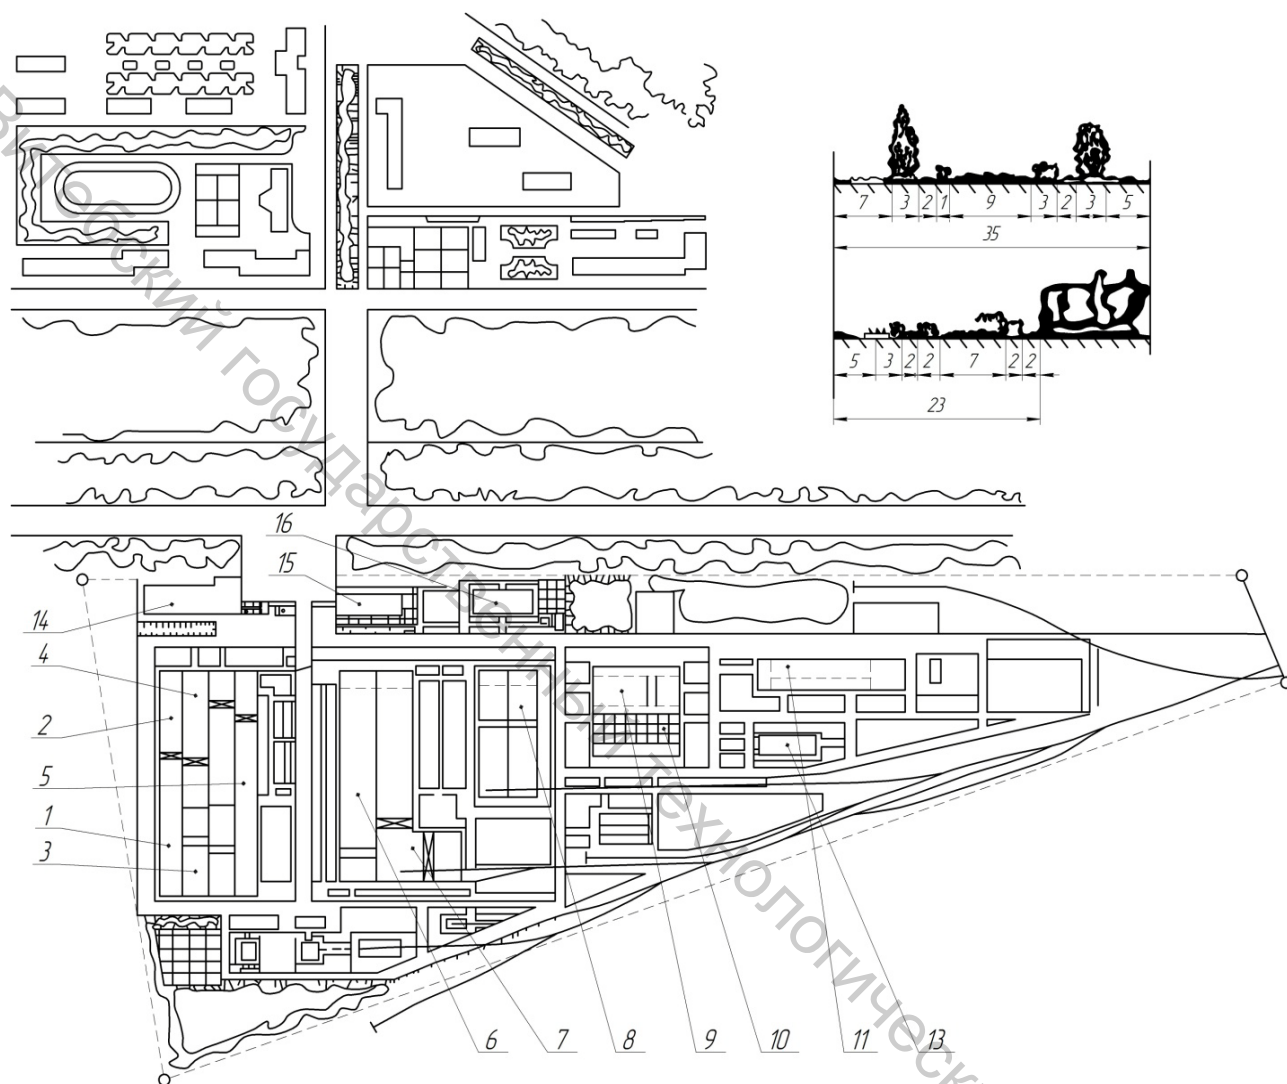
Генеральный план машиностроительного завода: 1 – инструментальный цех; 2 – ремонтно-механический цех; 3 – сборочный цех; 4 – механический цех; 5 – трубонарезной цех; 6 – кузнечный цех; 7 – склад металла; 8 – цех металлических конструкций; 9 – литейный цех; 10 – склад шихты; 11 – деревообрабатывающий цех; 12 – модельно-столярный цех; 13 – склад моделей; 14 – главная контора; 15 – охрана и медицинский пункт; 16 – лаборатория; 17 – спортивная площадка; 18 – жилые дома
